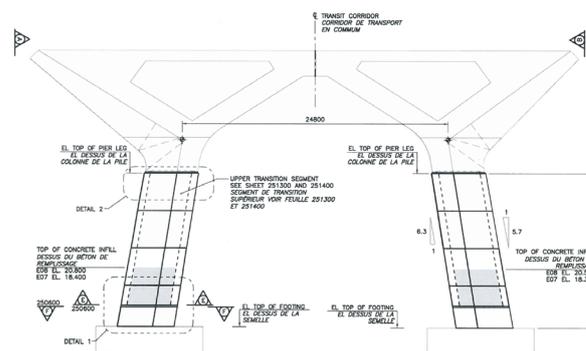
Geometría de las pilas de los viaductos de acceso del Nuevo Puente de Champlain
